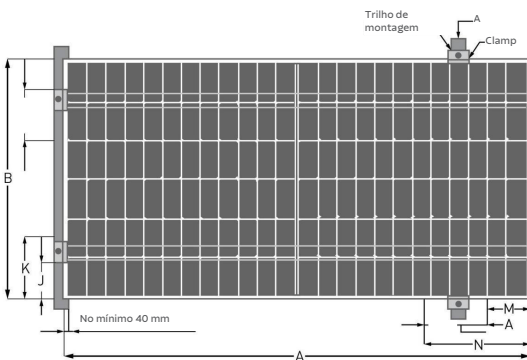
Instalação de braçadeiras no lado longo/curto da estrutura
